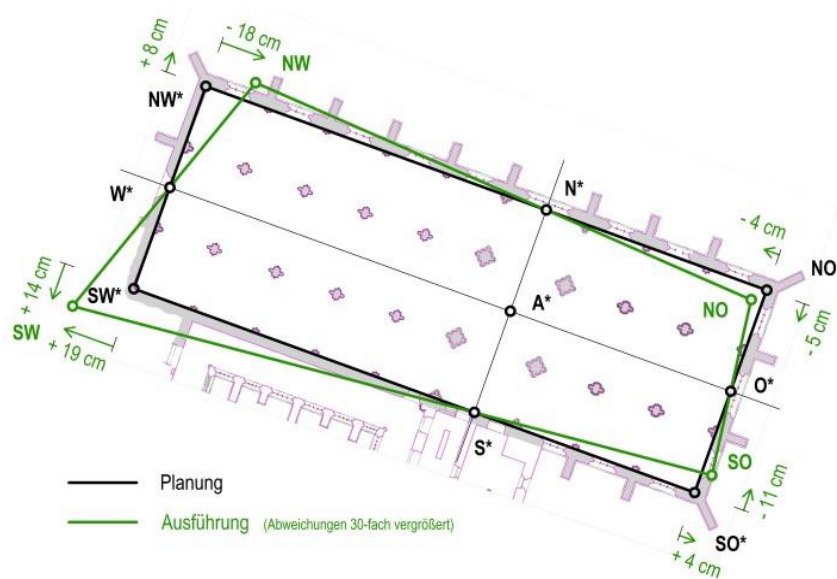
Münster Neuberg, Abweichungen zwischen Planung und Ausführung in stark übertriebener Darstellung (Abweichungen gegenüber Maßstab Grundriss 30-fach vergrößert).
